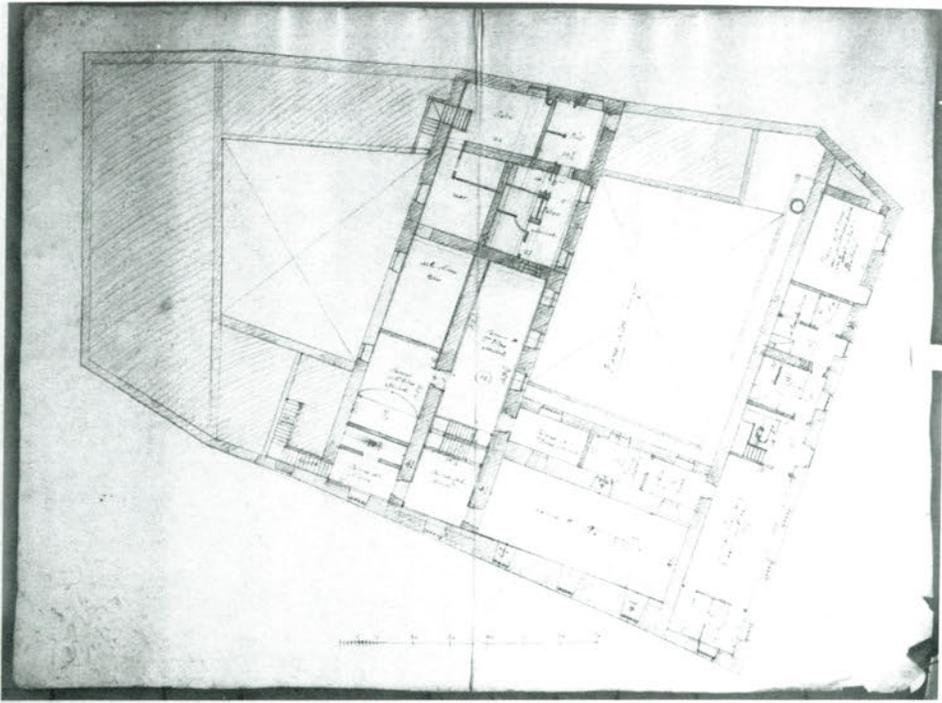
Casa de Rebeque, 1750. Planta de sotanos.
